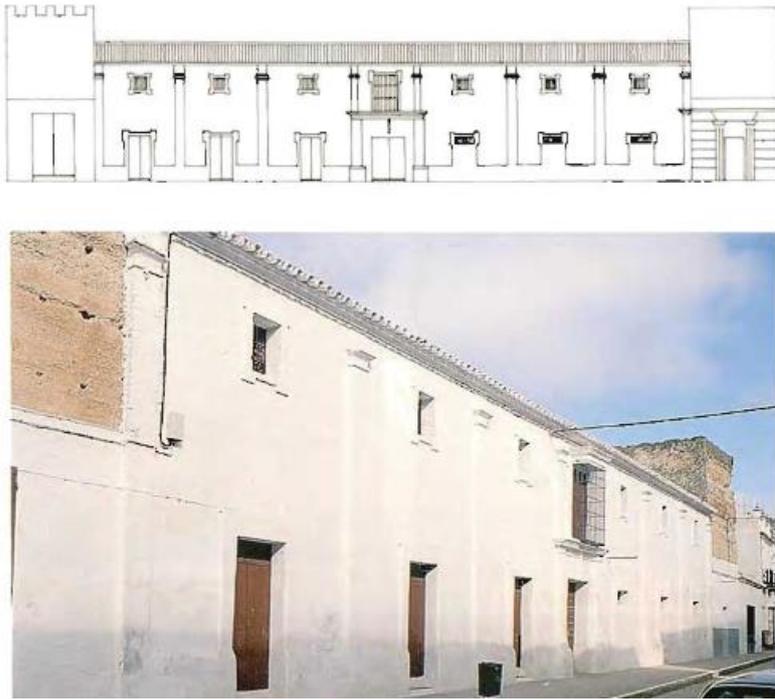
Plano de fachada y fotografía de fachada de los graneros de Marchena²²
